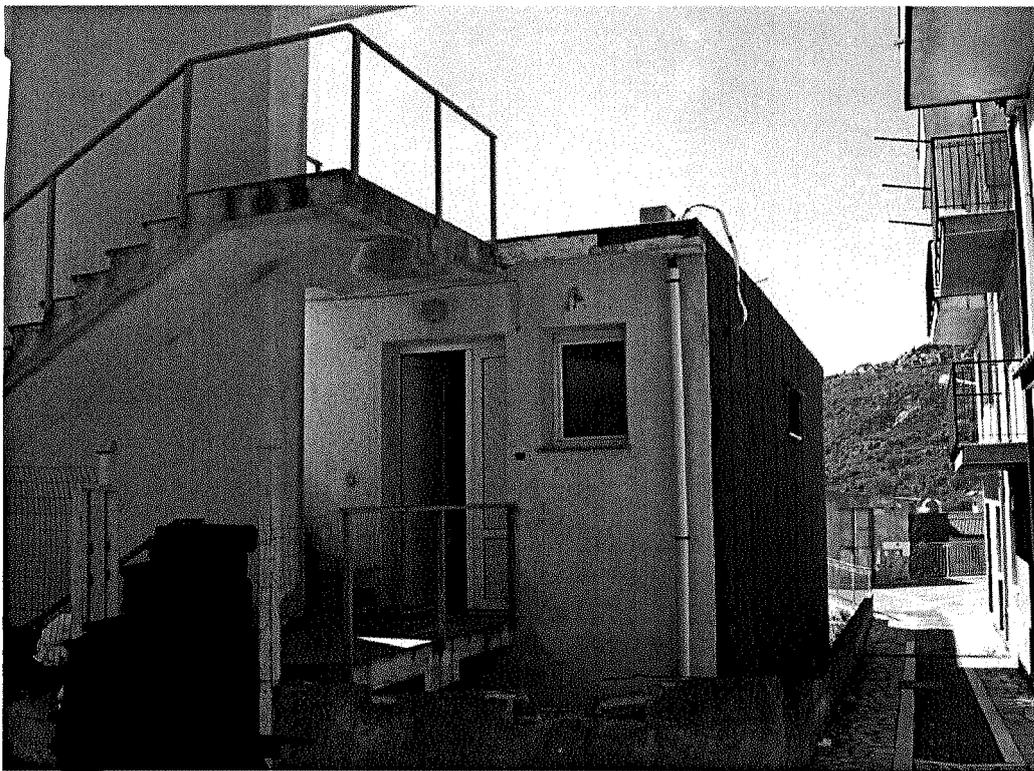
= per documentare il prospetto confinante con il Vico Stormo e l'altra porzione con scala a giorno sulla Via Stormo.
